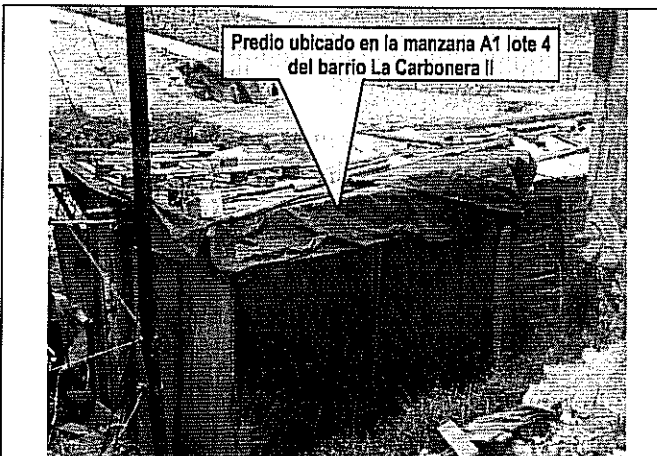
Evidencia de techo en zinc soportado por un entramado de madera de la vivienda localizada en la parte media del talud del barrio La Carbonera II.
